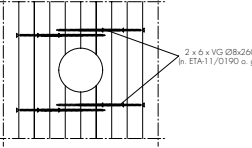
Schubanschluss Dachdeckenscheibe an Stahlbeton
